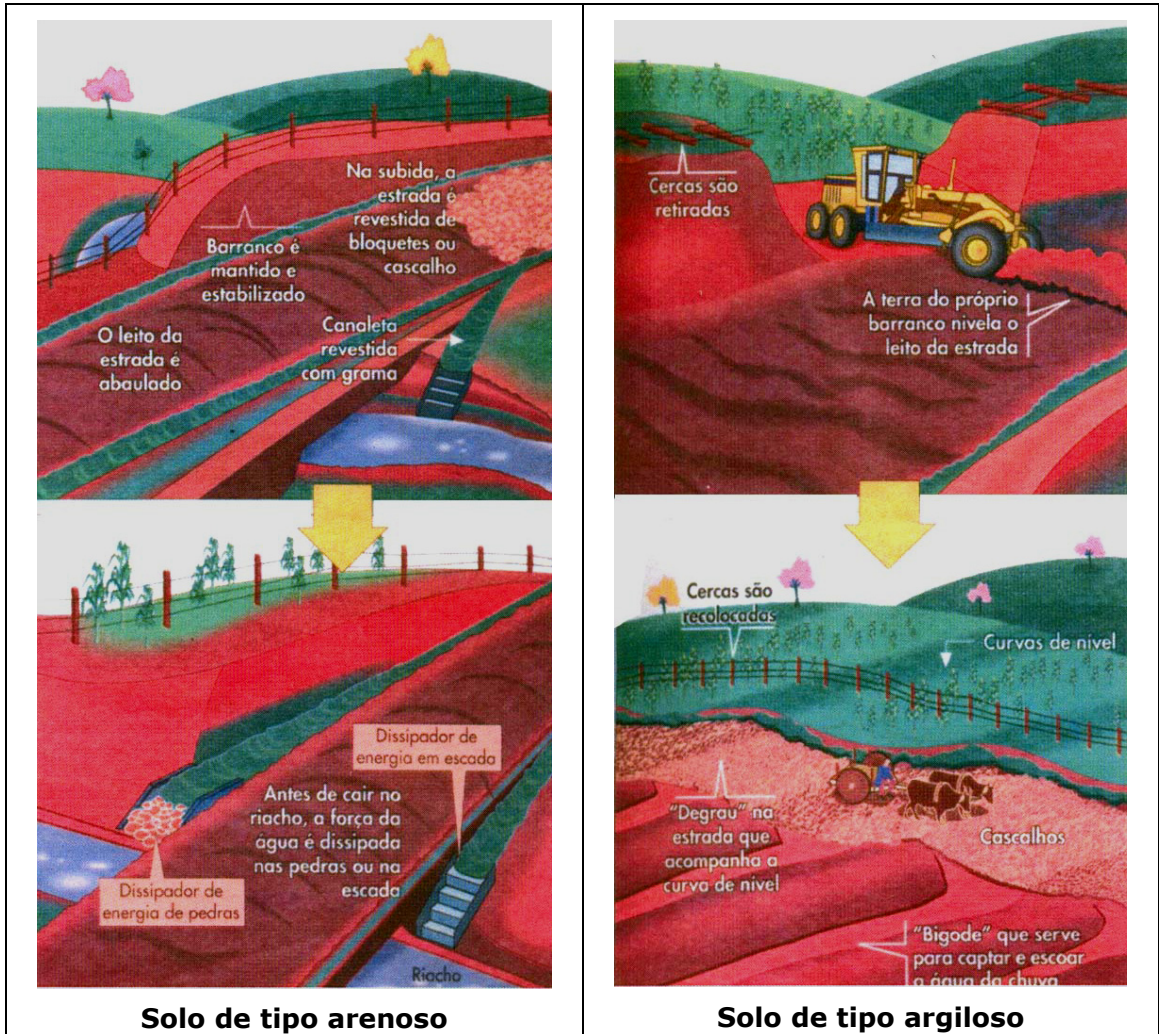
Recomendações para intervenção em rodovia não-pavimentada
